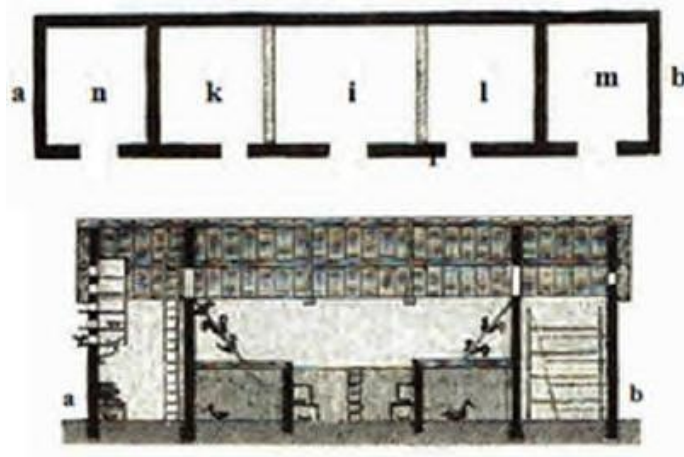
plan et coupe d'un poulailler. Source: Bouchard-Huzard,Louis. *Traité des constructions rurales.* Ed 1, 1982, P.192.
